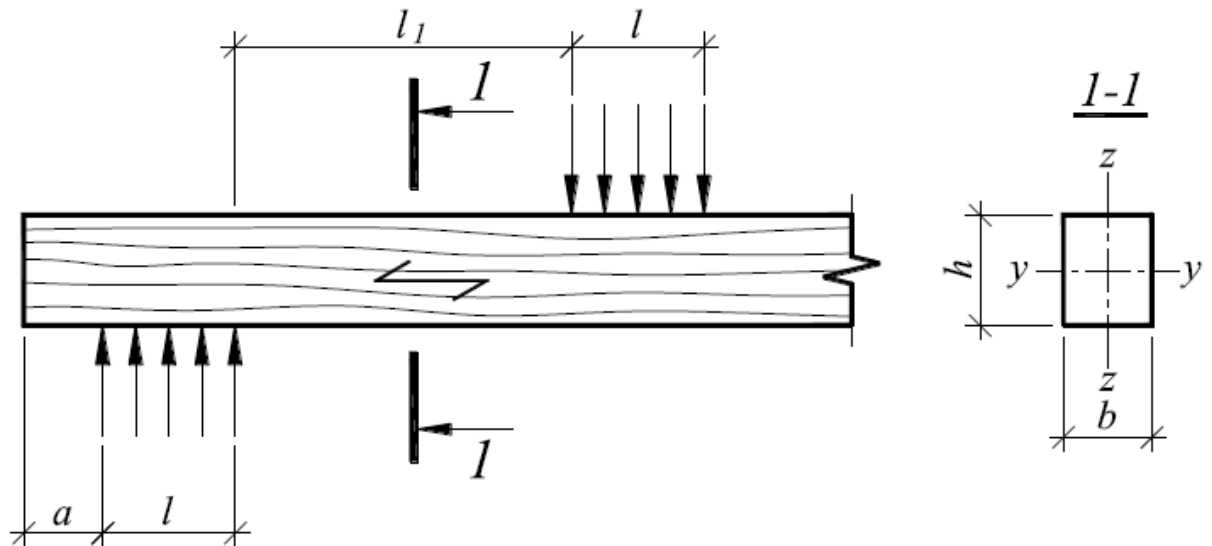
Схема опирания элемента на отдельные опоры
